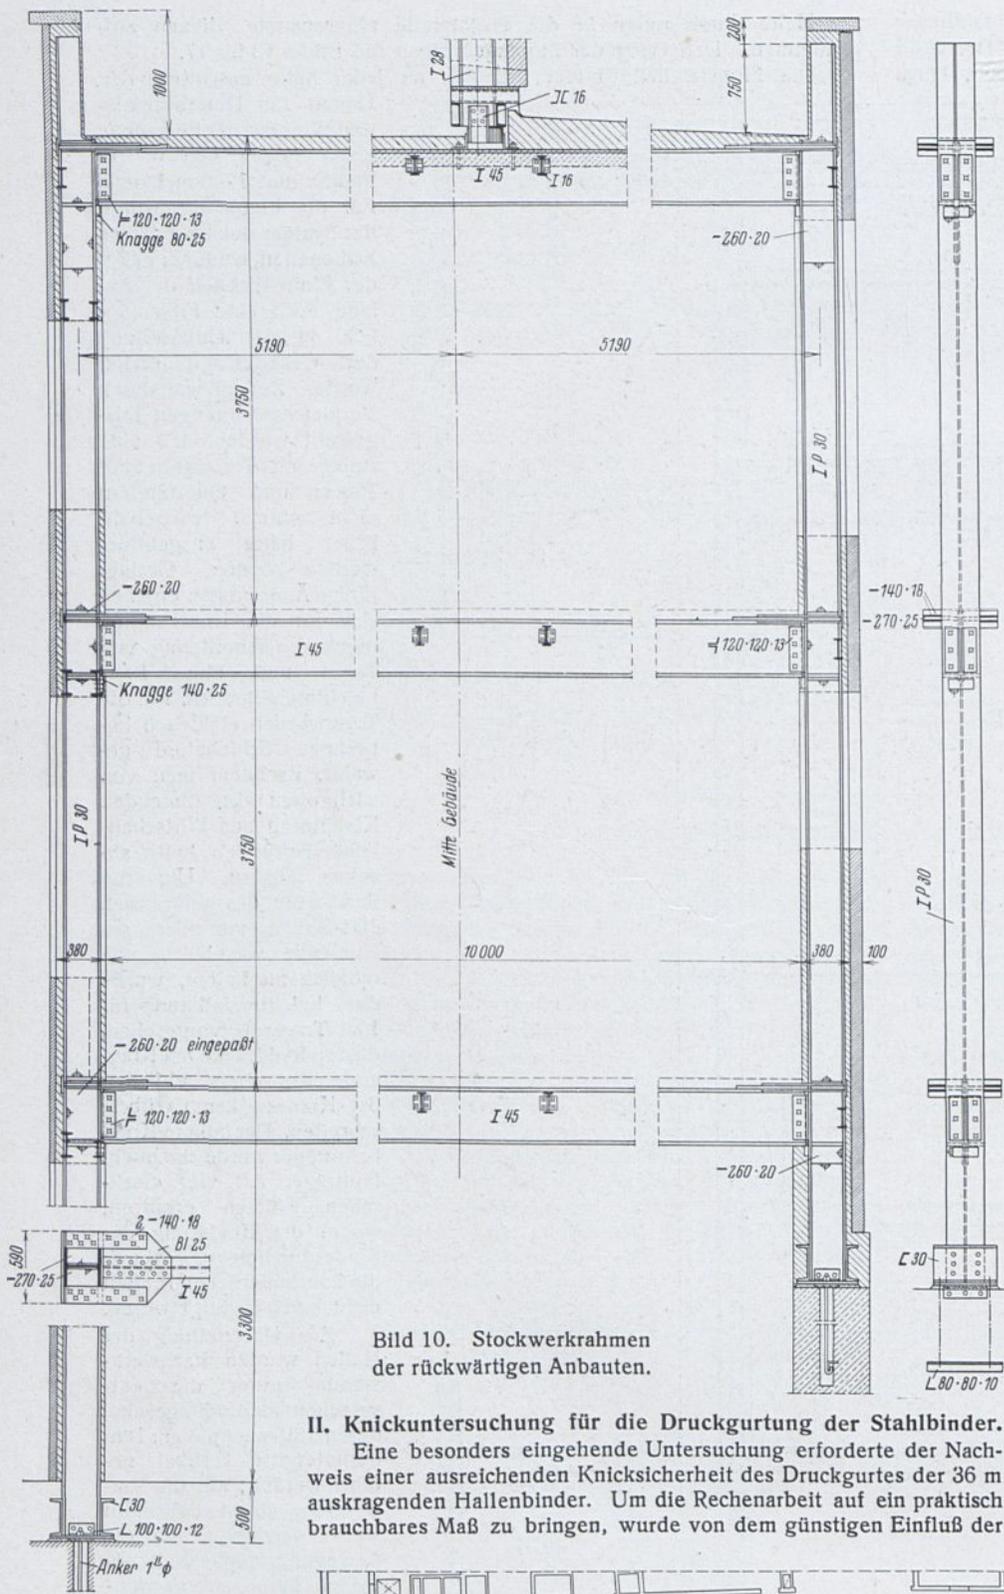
Stockwerkrahmen der rückwärtigen Anbauten.
